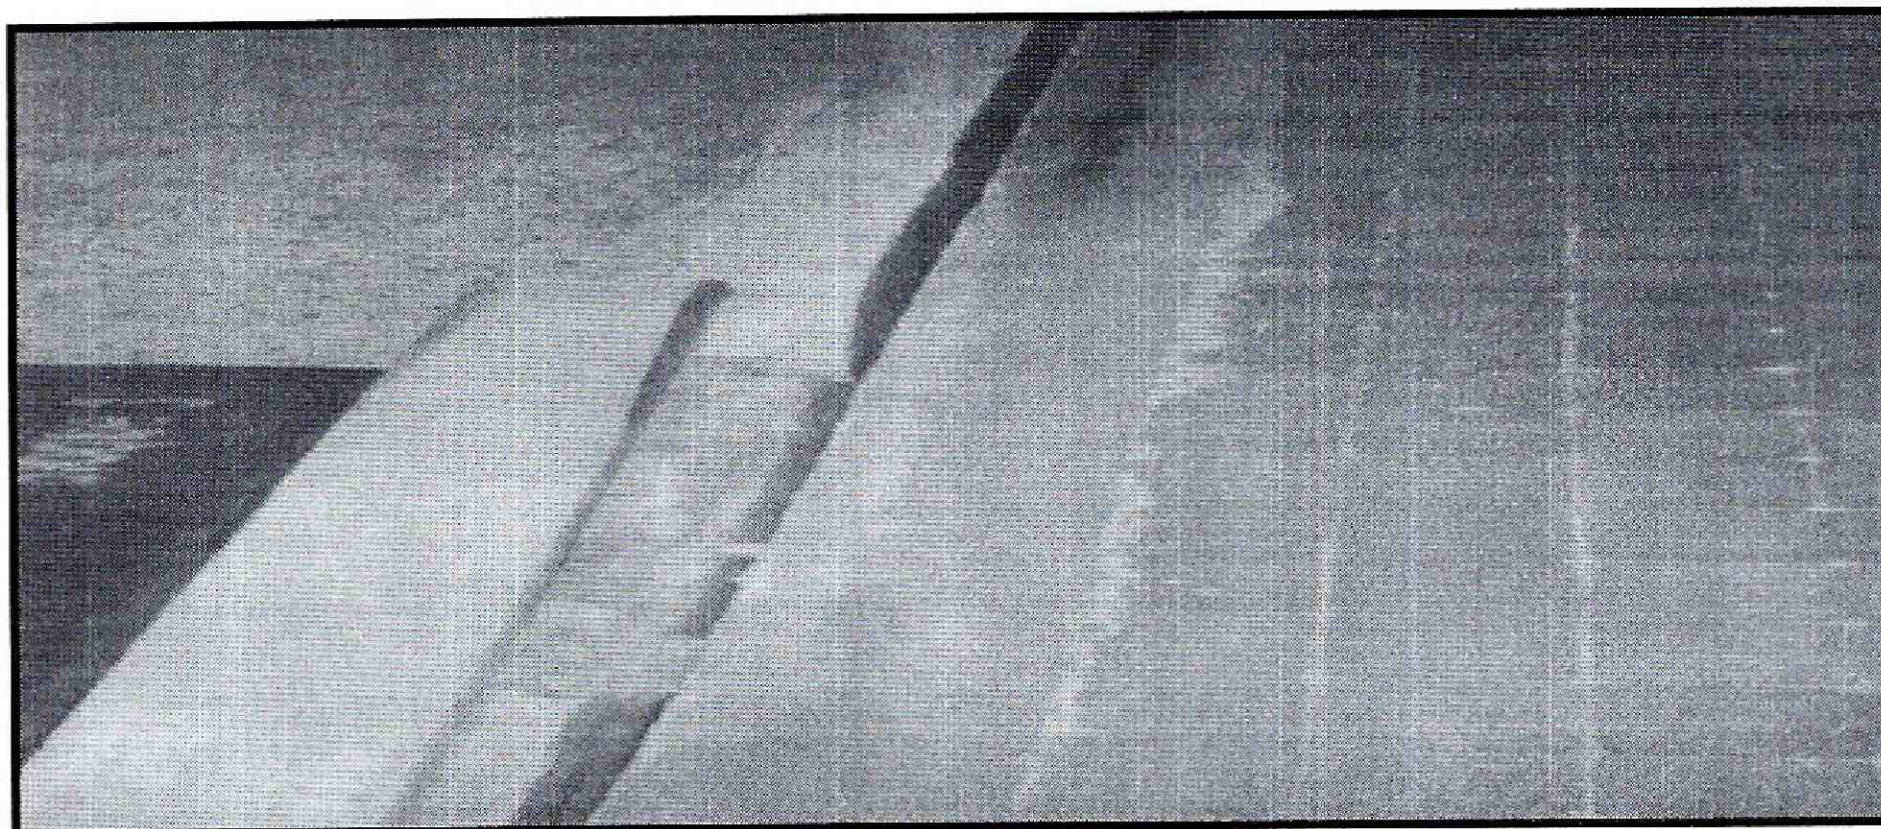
y 17. Fisuras de tendencia longitudinal en la parte inferior de la torta superior de la placa de primer piso.
